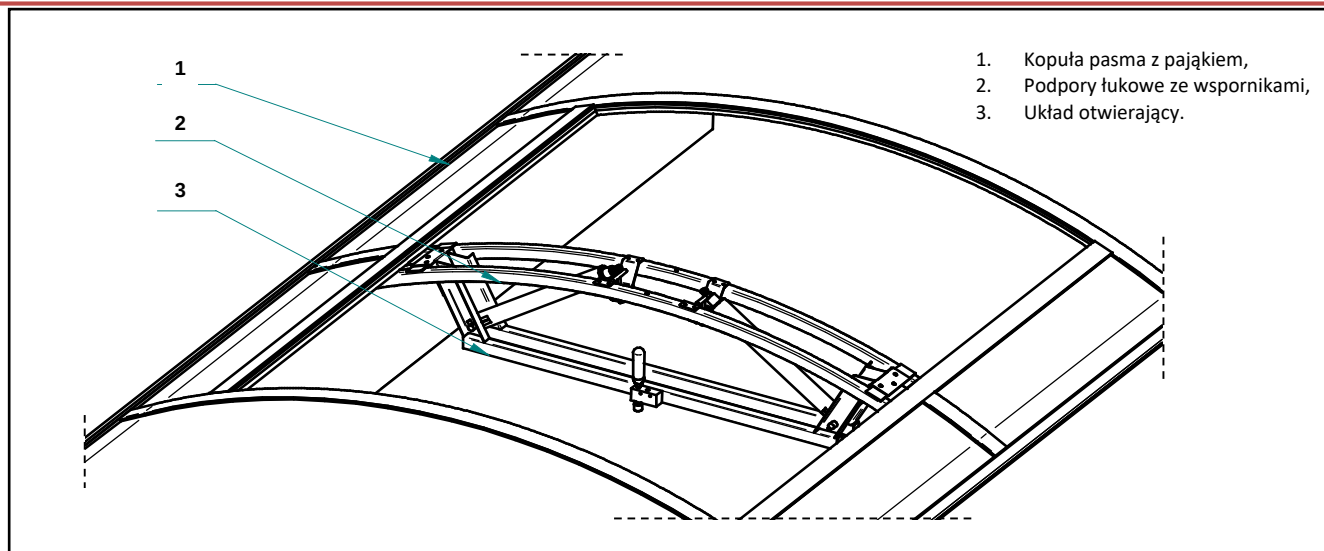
Przykładowe pasmo świetlne przygotowane do montażu klapy
